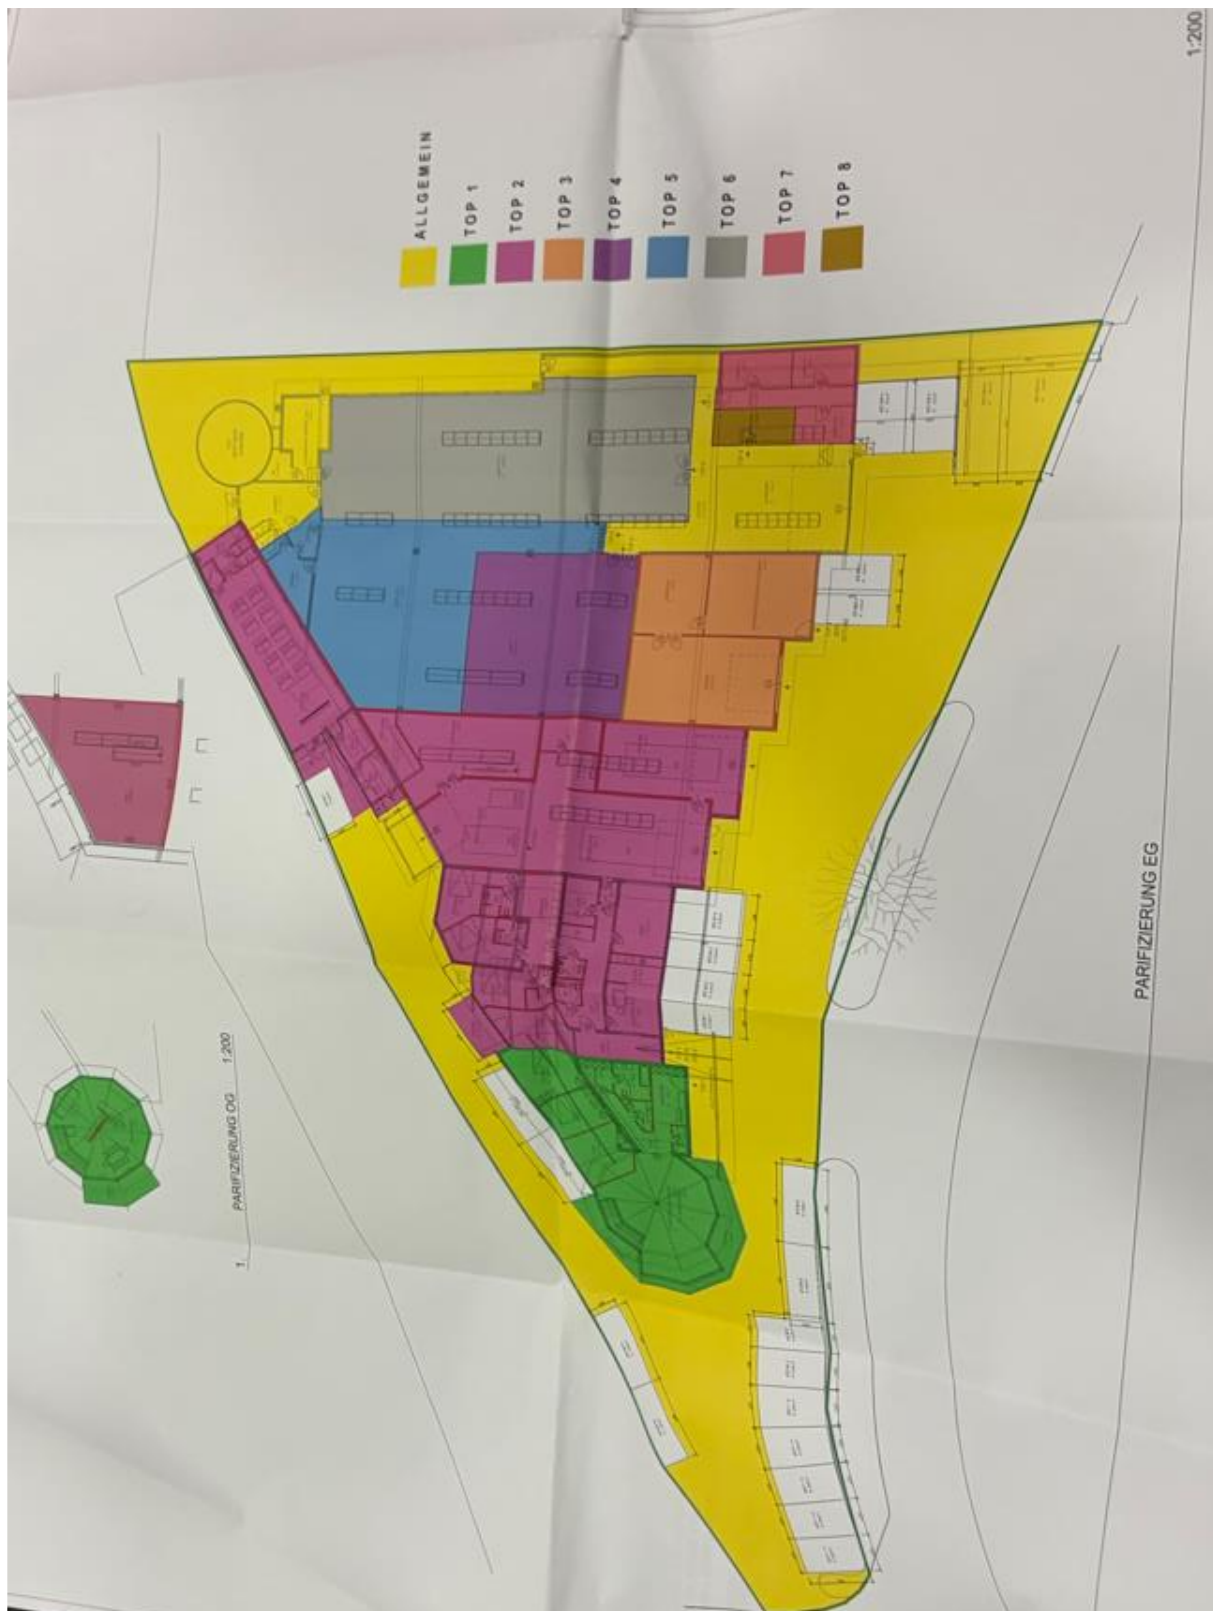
Grundriss EG – gem. Parifizierungsgutachten (v. 12.05.2019, TZ 4586/19)¹⁵
